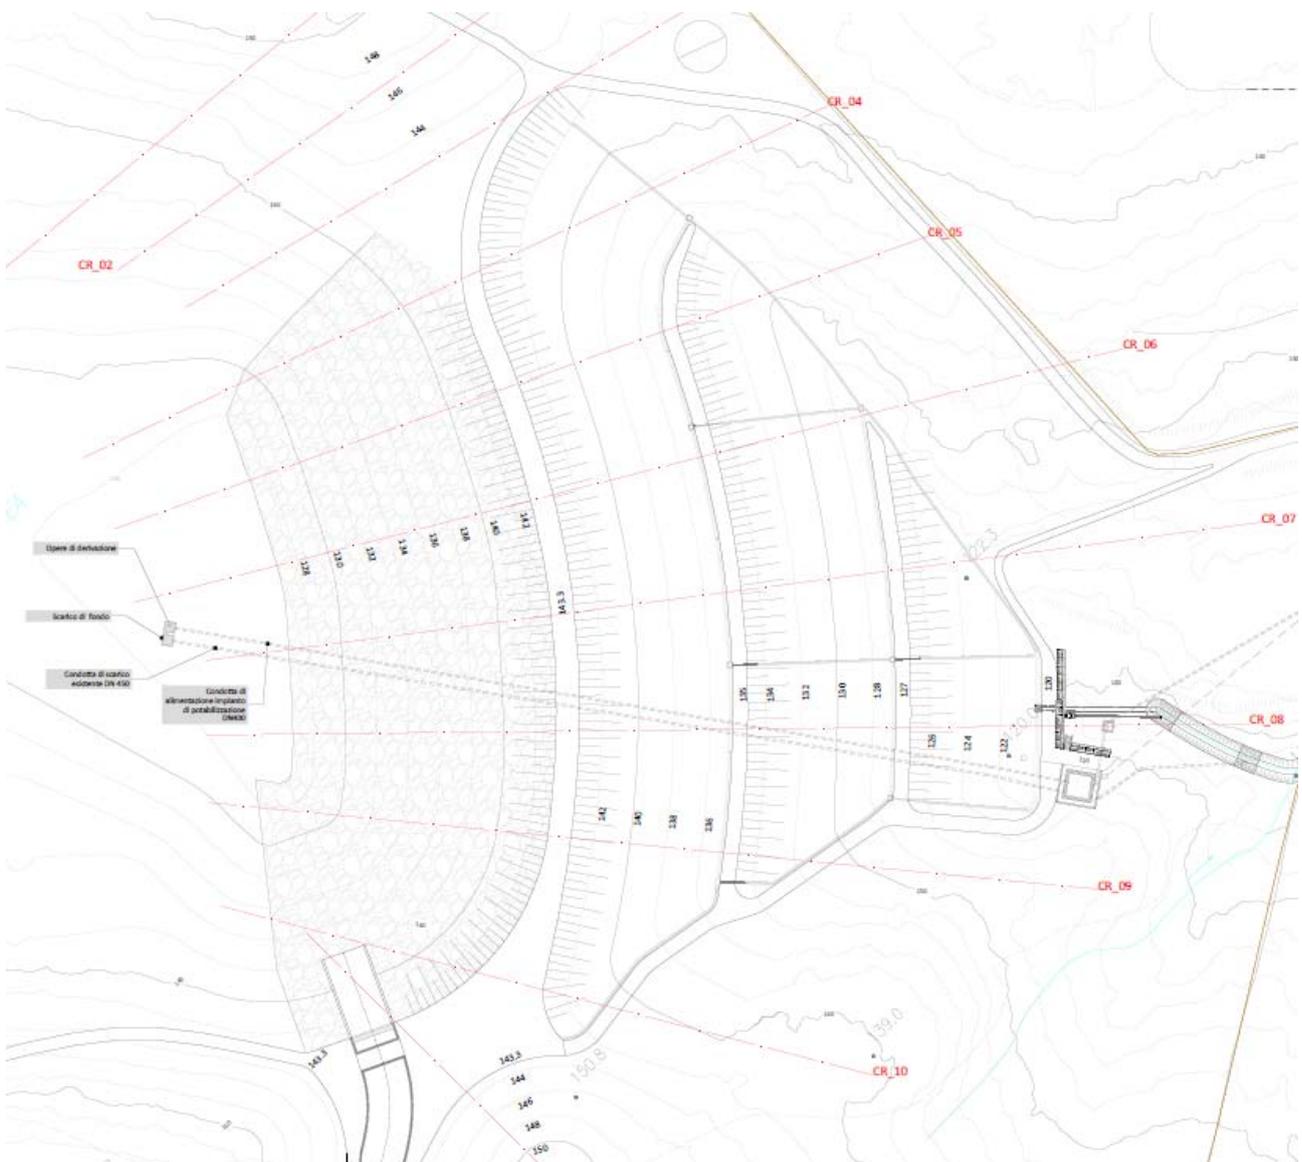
Planimetria dell'invaso nello stato di progetto
